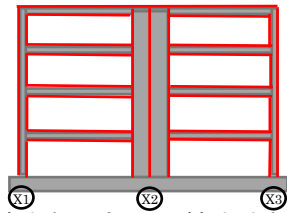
ひび割れ幅測定・ひび割れ本数カウント箇所
